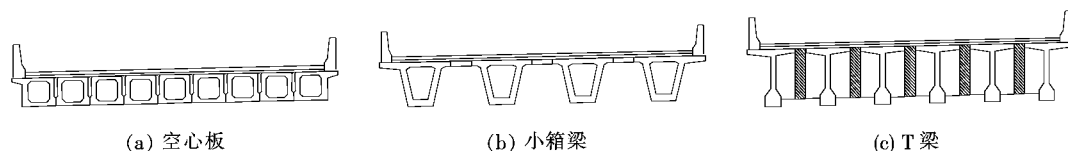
预应力混凝土空心板、箱形组合梁、T梁横断面图
